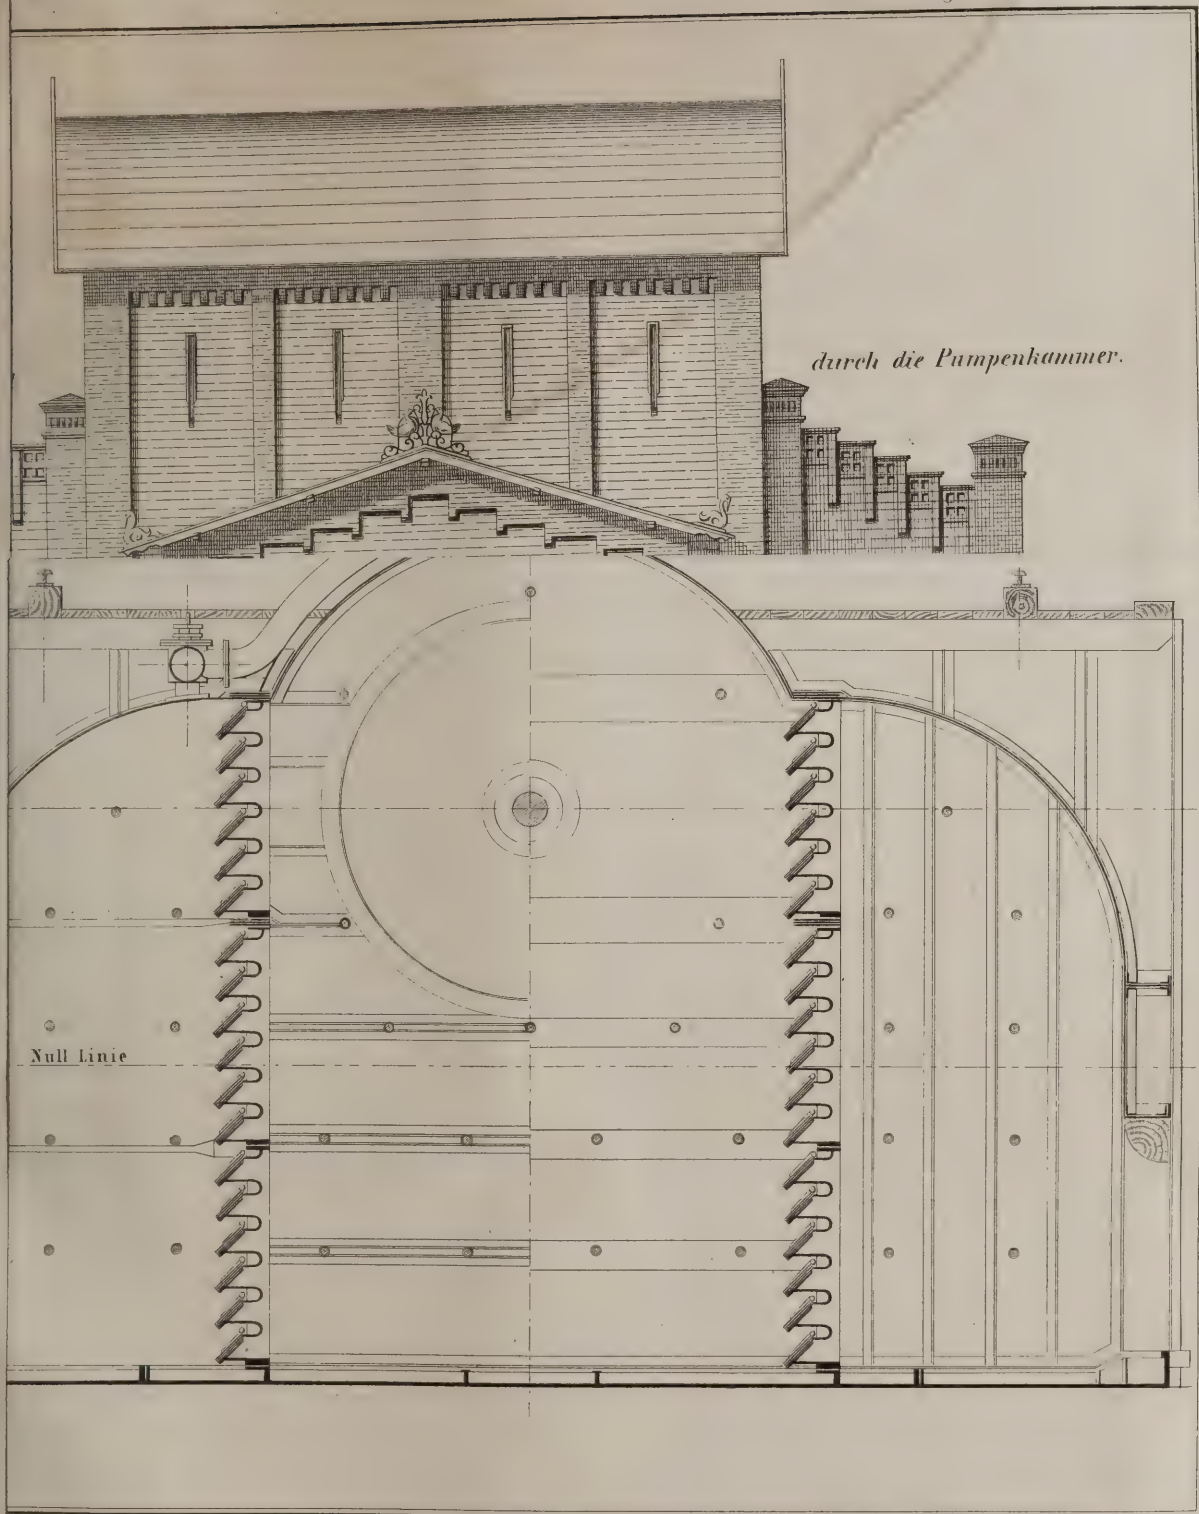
Grundriss u. Horizontaldurchschnitt.
